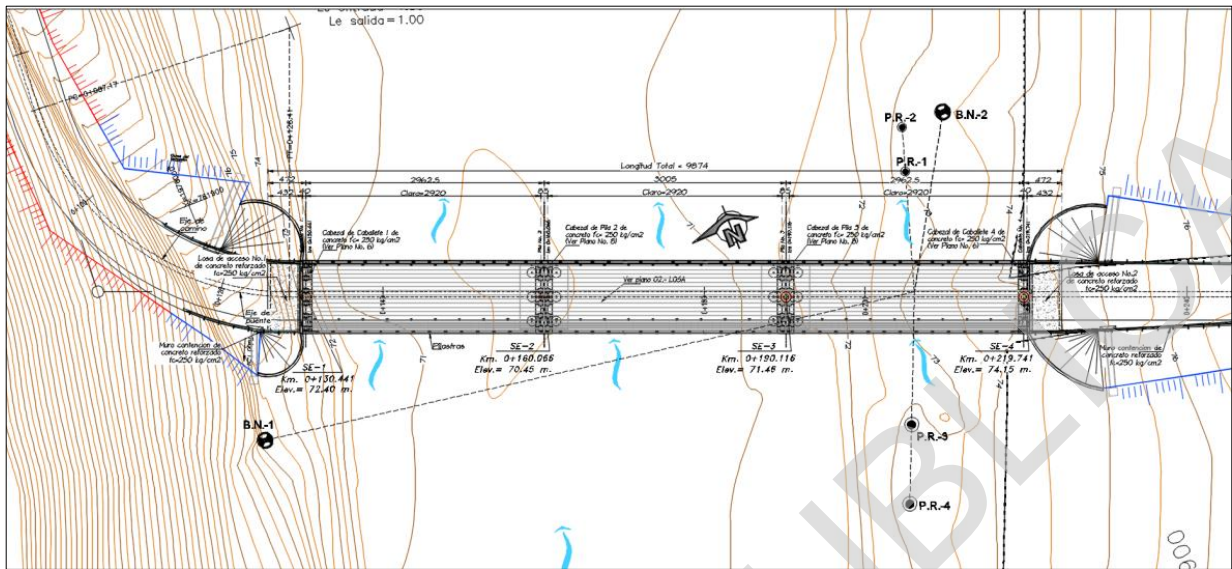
Planta general del proyecto de construcción del puente "Tlatepusco".
